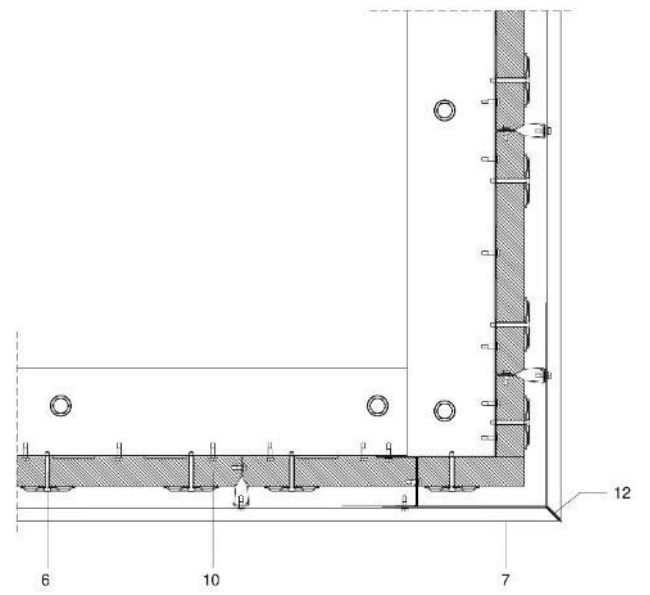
d: Detalle de esquina saliente con aislamiento térmico.
